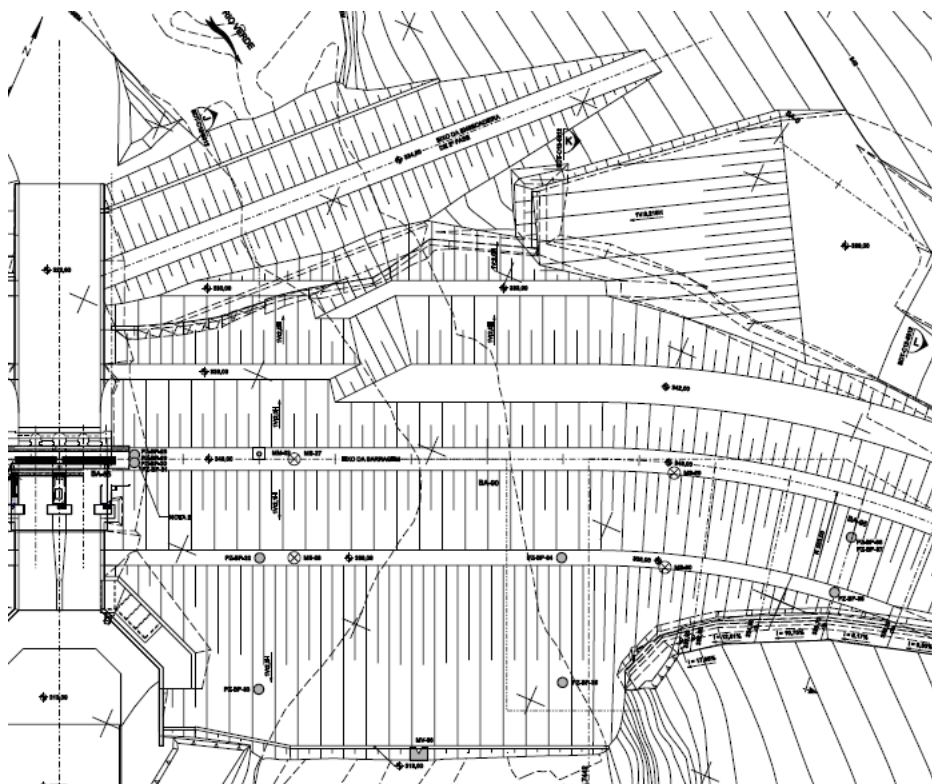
DESENHO DA BARRAGEM – VISTA EM PLANTA
